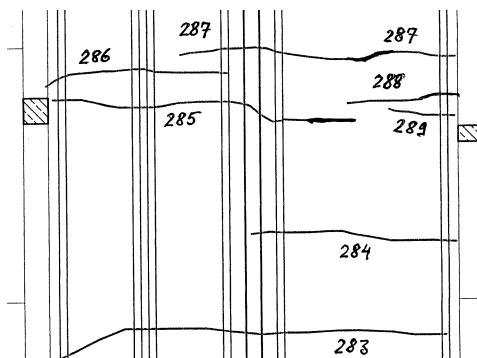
Grundrissplan mit eingezeichneten nummerierten Rissen als Rissplan zur Grundlage der Dokumentation der Rissinjektionen
